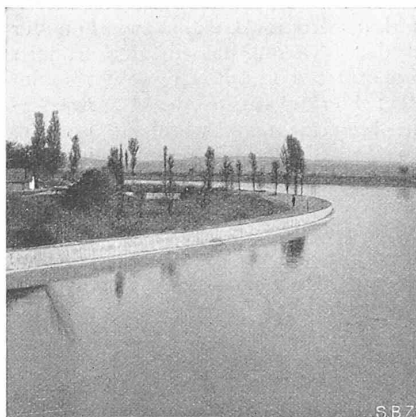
Uferverbauung mit Betonplatten, System Schaub, oberhalb Strassenbrücke Rüdlingen.
